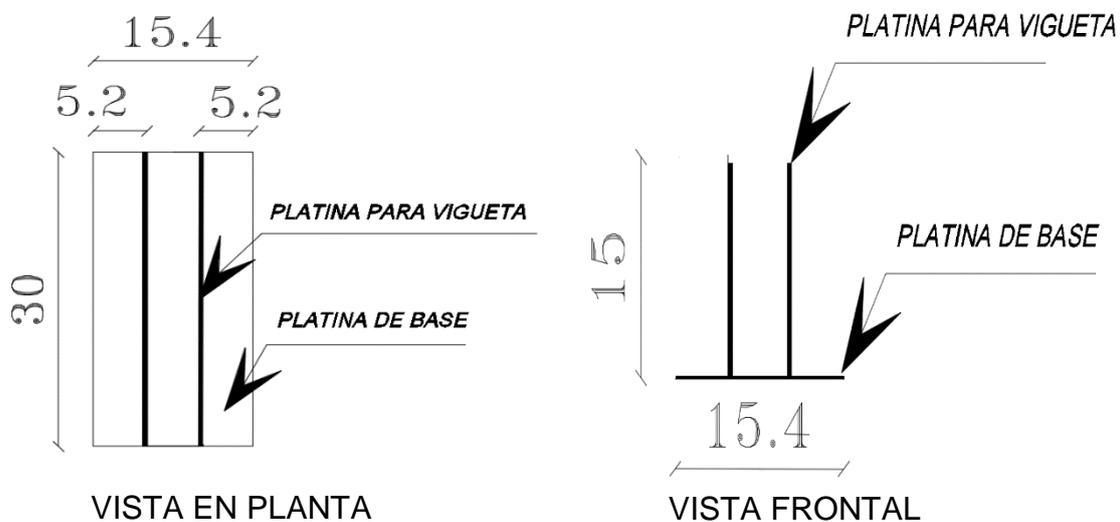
Detalle de platinas acople poste a viga y vigueta de cubierta
